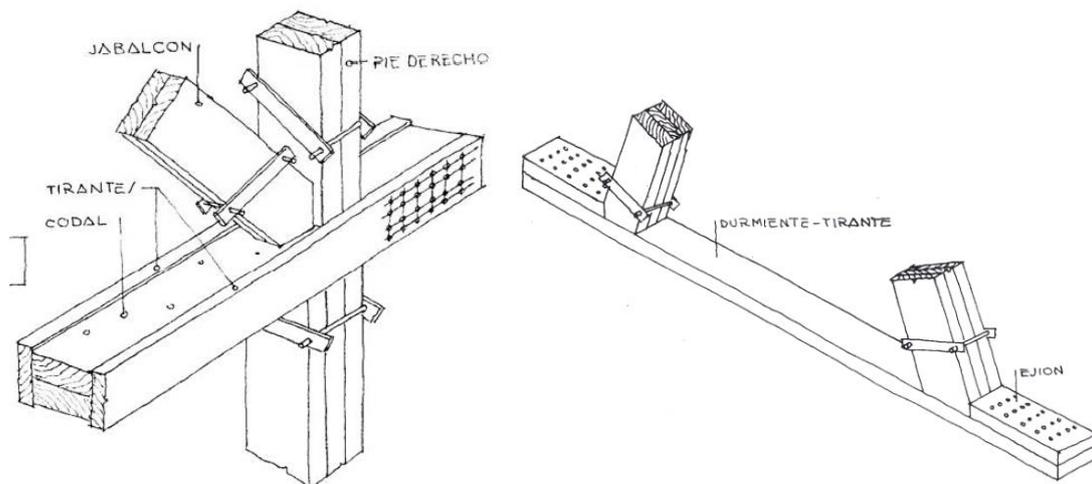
Tirante de madera en apeo jabalconado y en tornapuntas contrapuestas.
